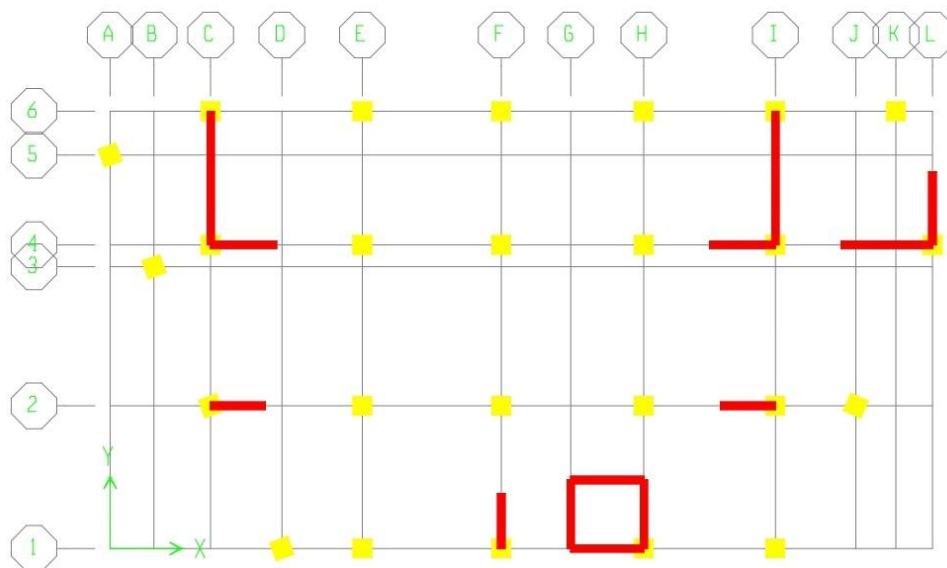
Disposition des voiles de contreventement en plan - proposition 2
